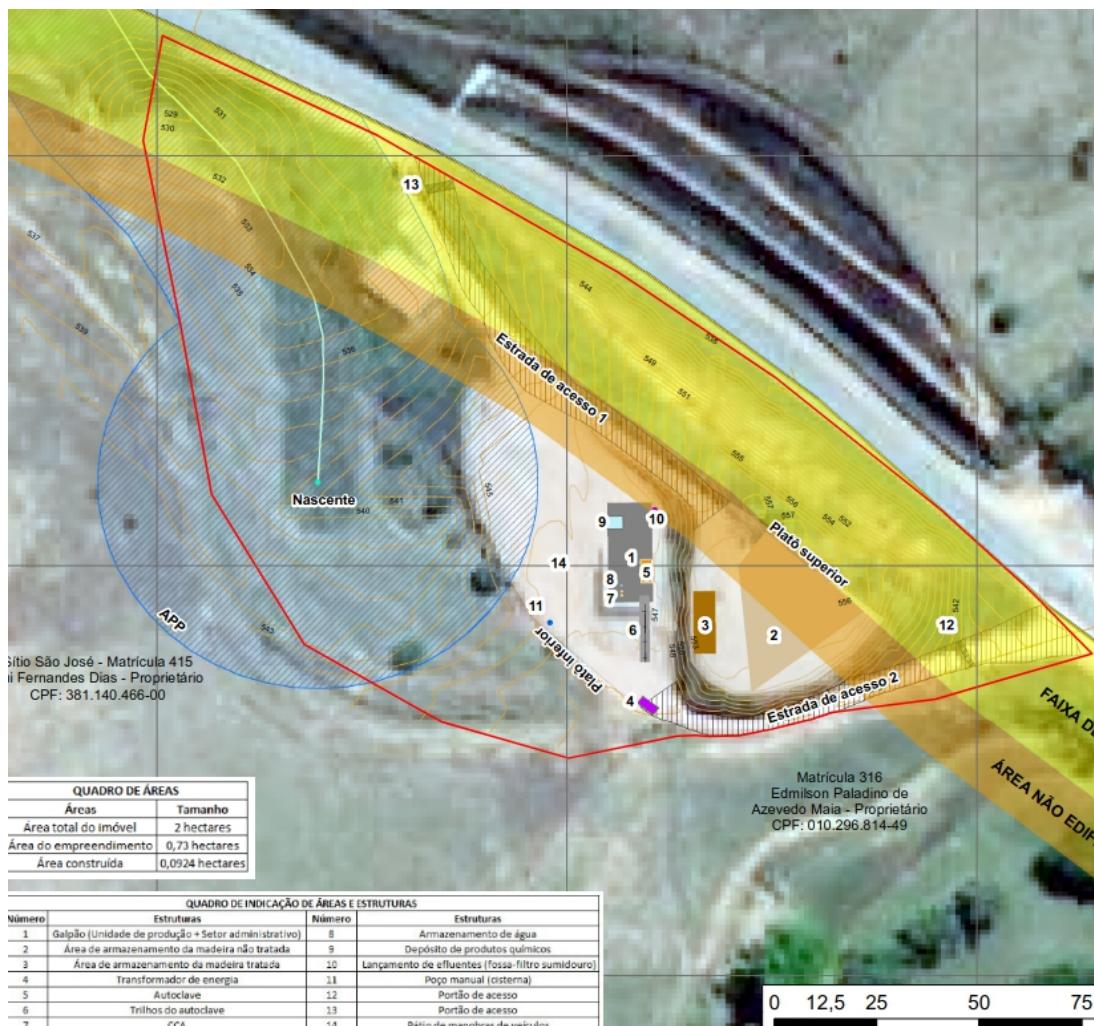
Parte da Planta apresentada com o novo layout do empreendimento em função da remoção das estruturas em APP. Fonte: Informações Complementares.
